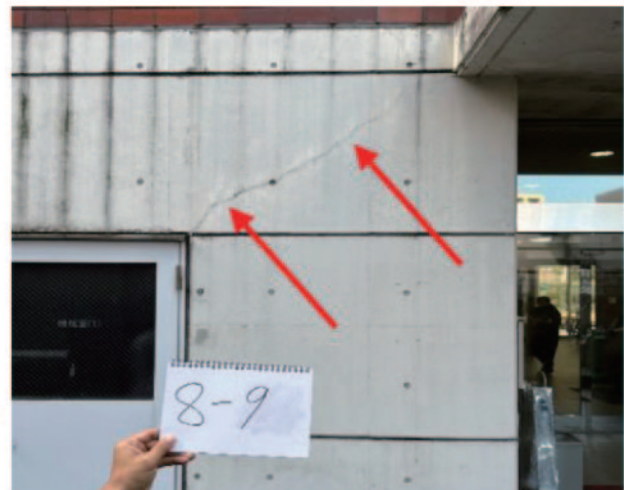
典型的な乾燥収縮によるひび割れ
